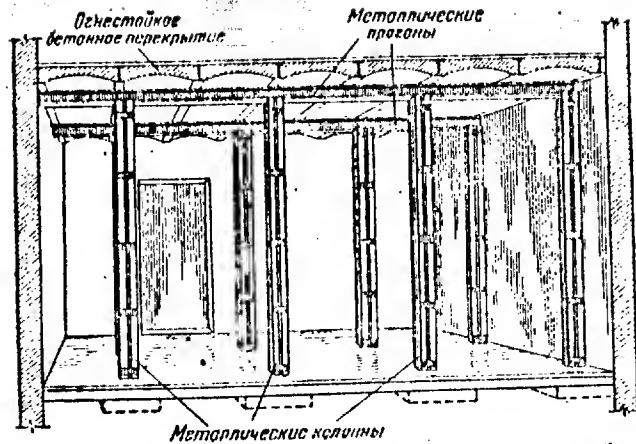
Усиление перекрытия над убежищем (Reinforcement for Shelter Ceiling)
